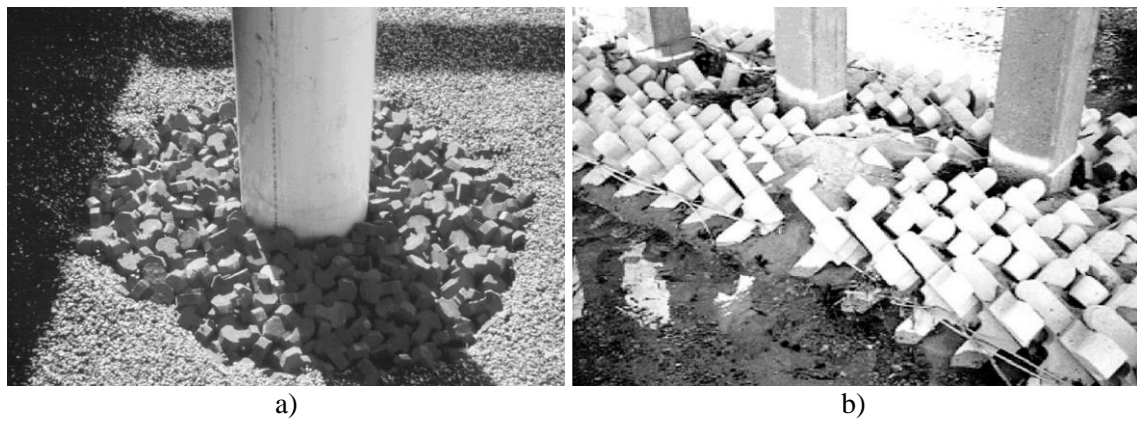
Protección en pilas de puentes con elementos prefabricados de concreto del tipo (Lagasse et al., 2012): (a) Toskano y (b) Jack.
